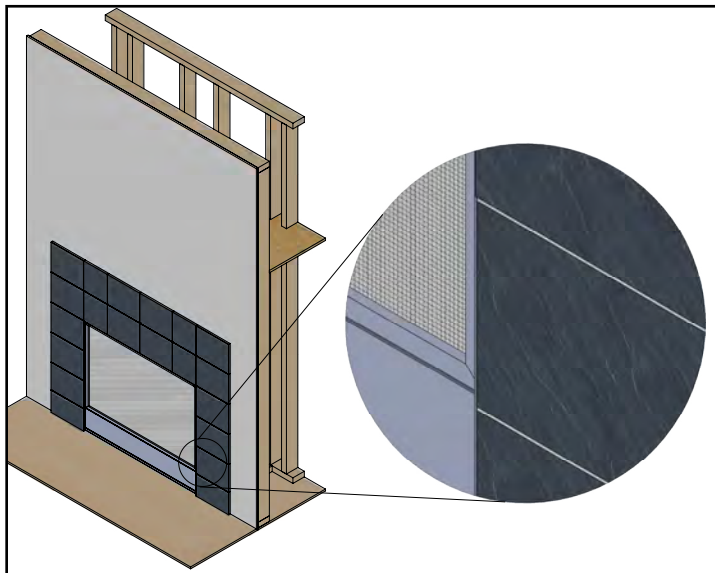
Carrelage sur la façade du foyer et sur les cloisons sèches
